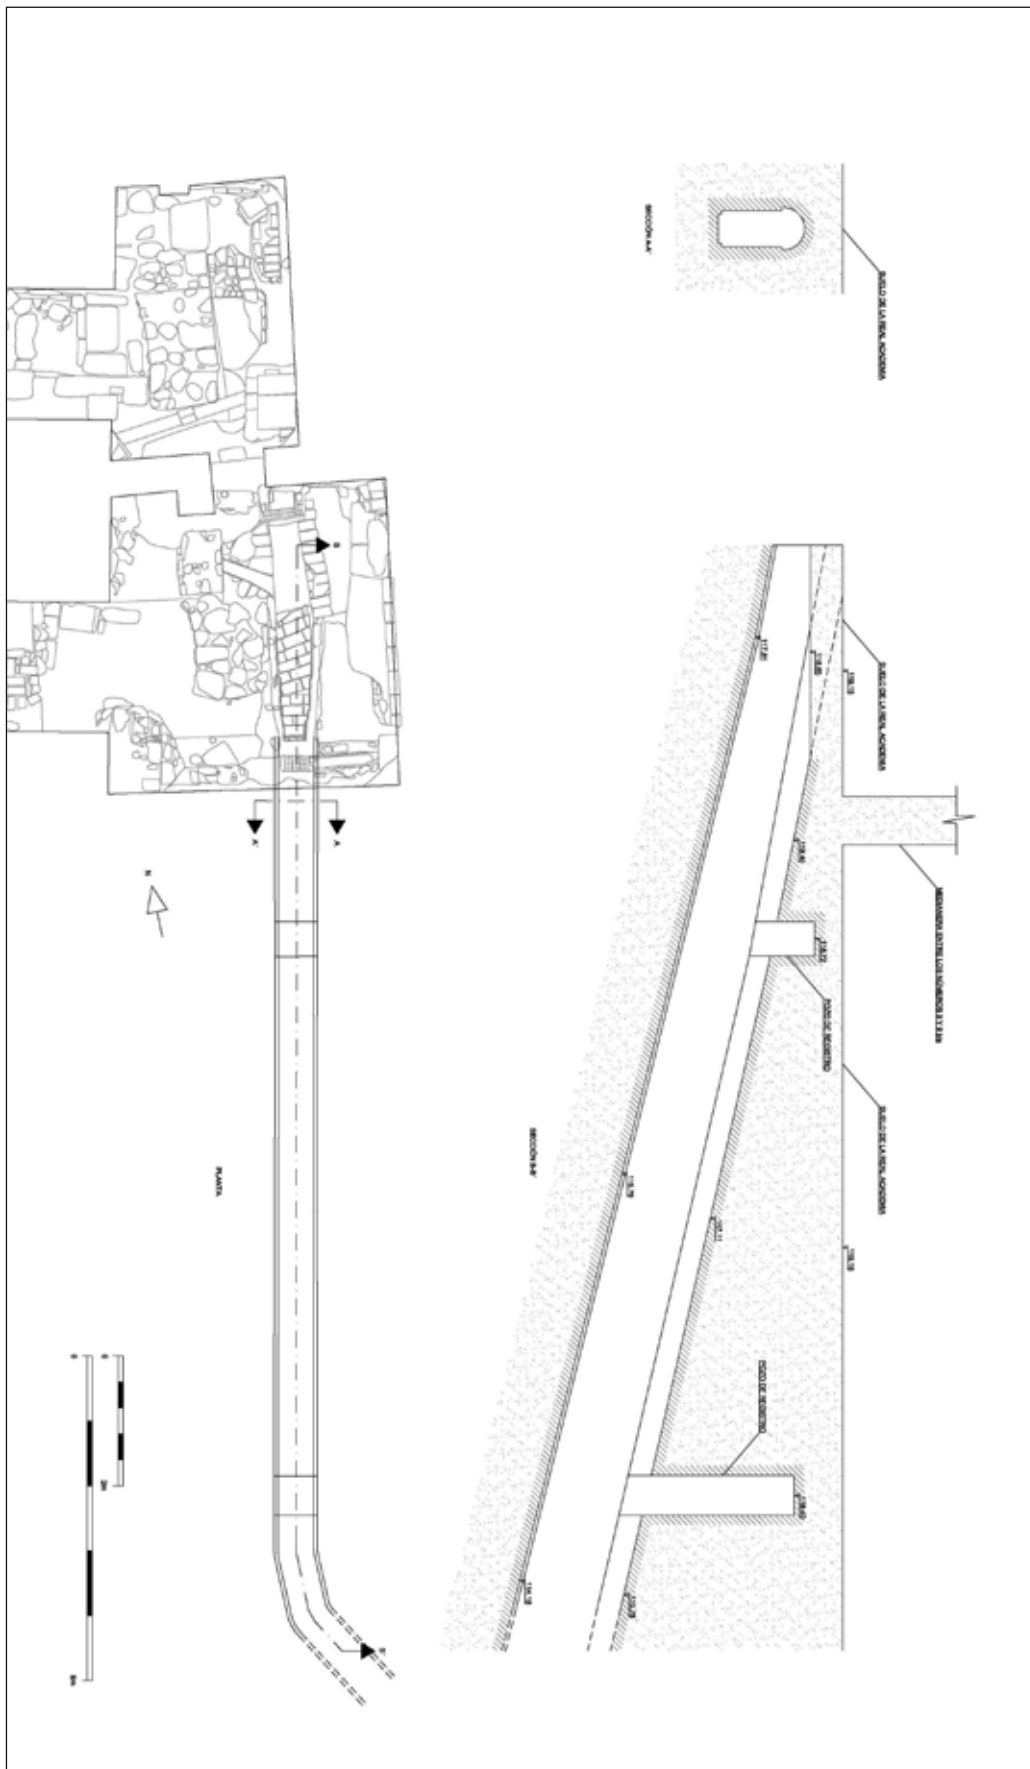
Planta y sección de la canalización moderna (U.E. 16).
